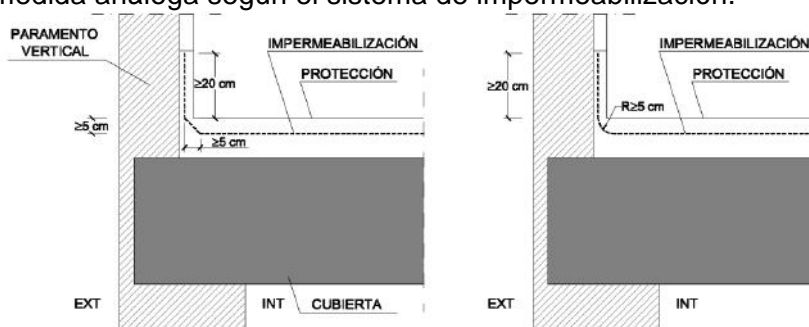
Encuentro de la cubierta con un paramento vertical
